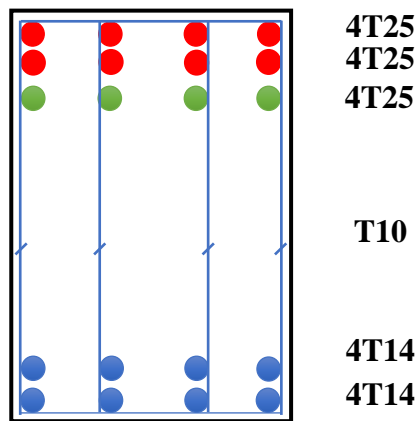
Ferrailage de la poutre de libage (sens longitudinal)
